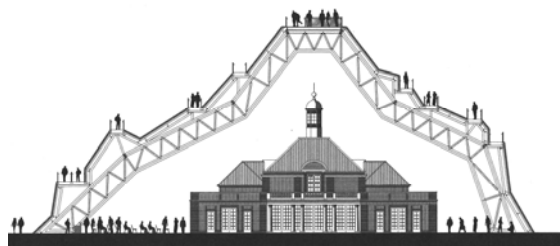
Corte, pavilhão da MVRDV, 2004.
